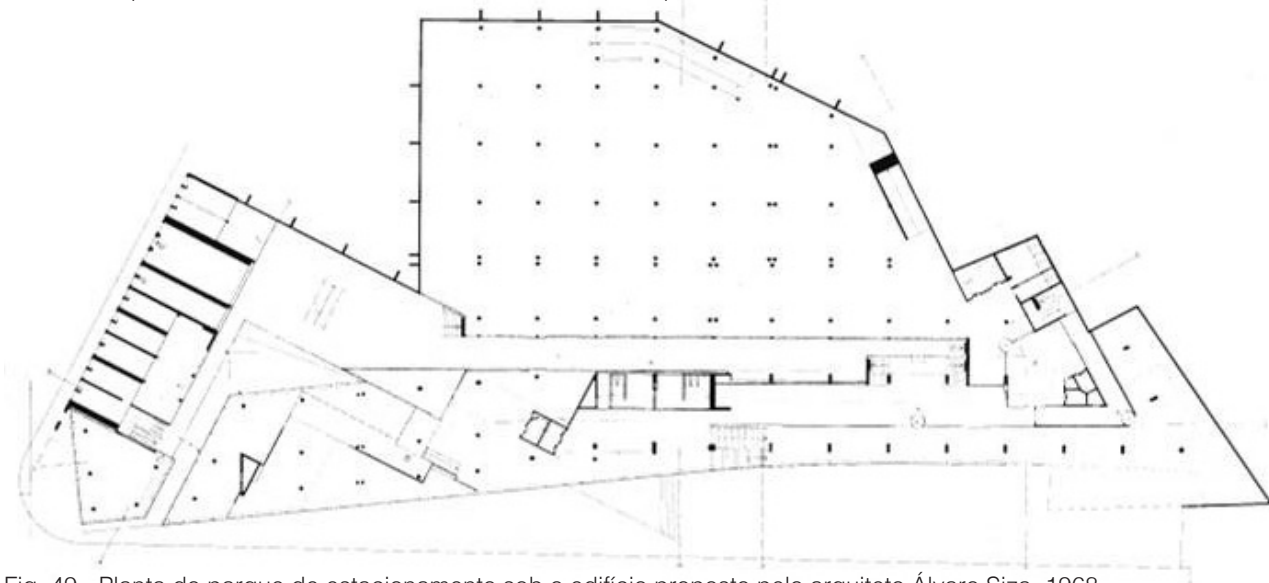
Planta do parque de estacionamento sob o edifício proposto pelo arquiteto Álvaro Siza, 1968
